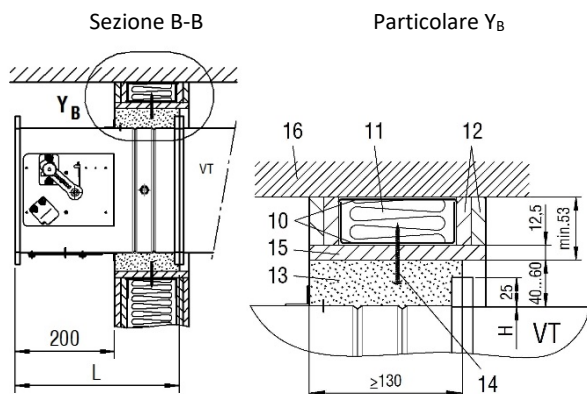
montaggio a umido in pareti divisorie leggere direttamente sotto soffitti massicci
